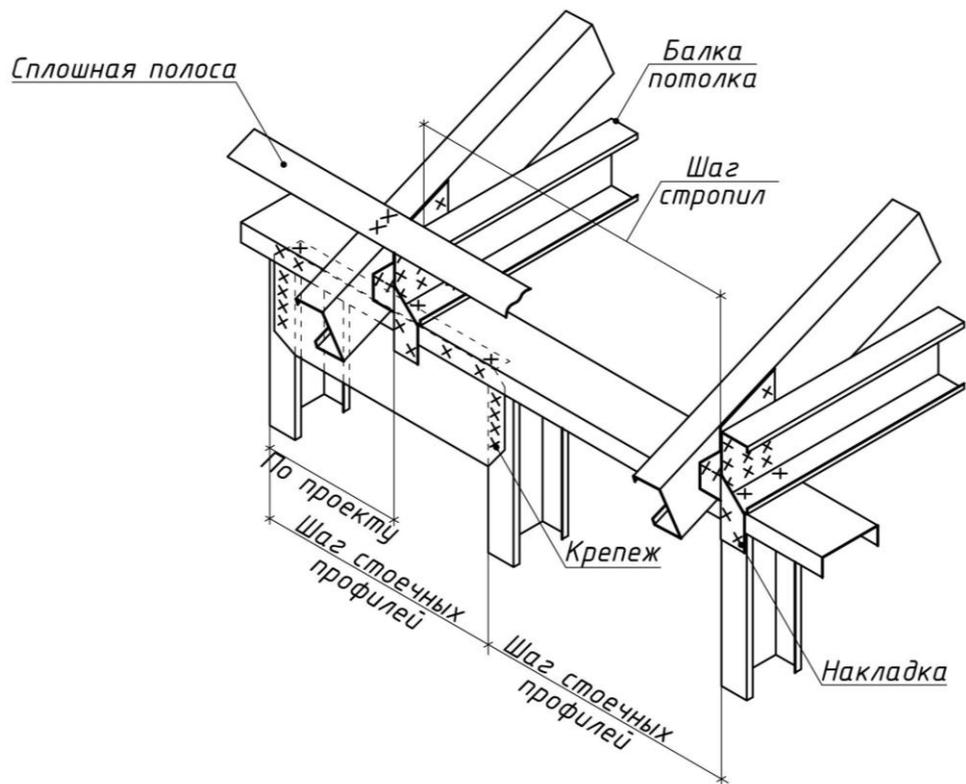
Узел К 12. Конструкция кровли без выравнивания
